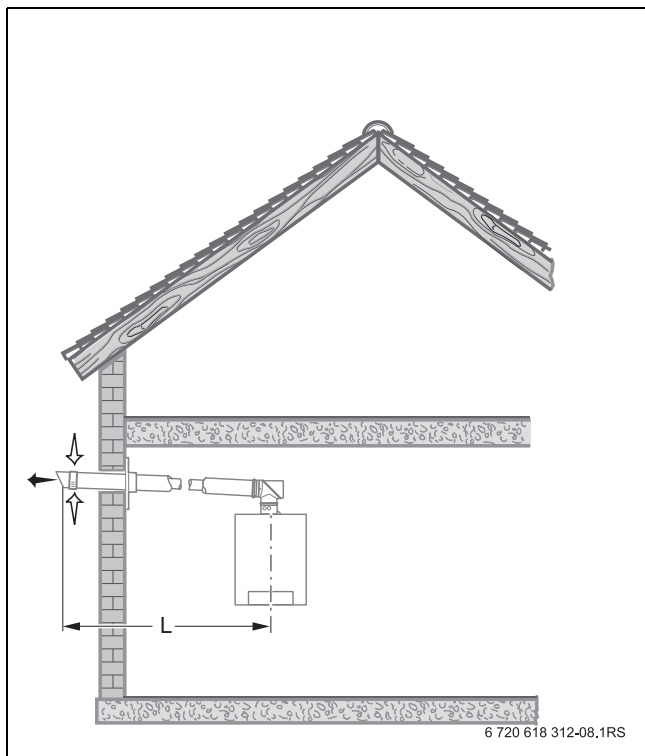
Montážní varianta se stavební sadou GA-X + ÜB-flex
